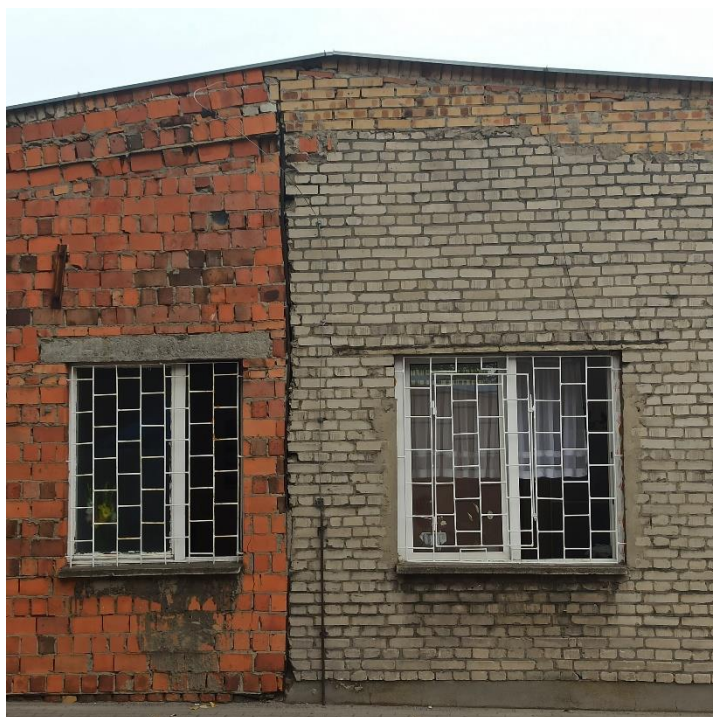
Elewacja południowa – brak otynkowania na ścianach zewnętrznych i opaski betonowej
